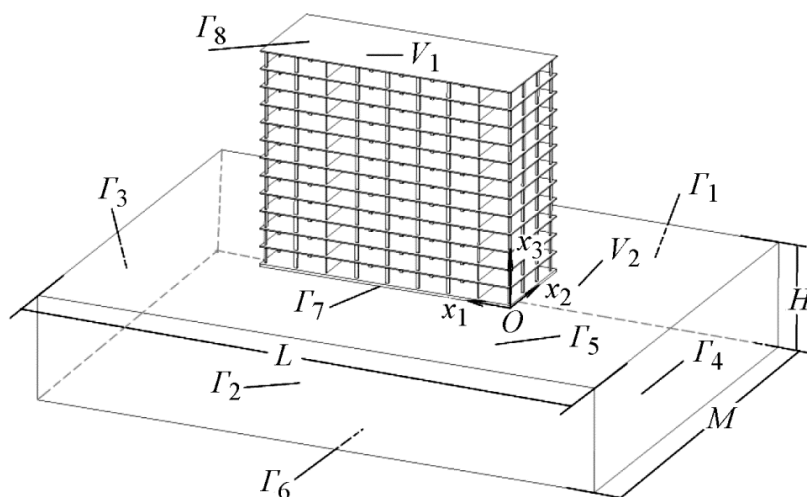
Задача об оценке НДС системы «монолитное здание – фундамент – грунтовое основание»
